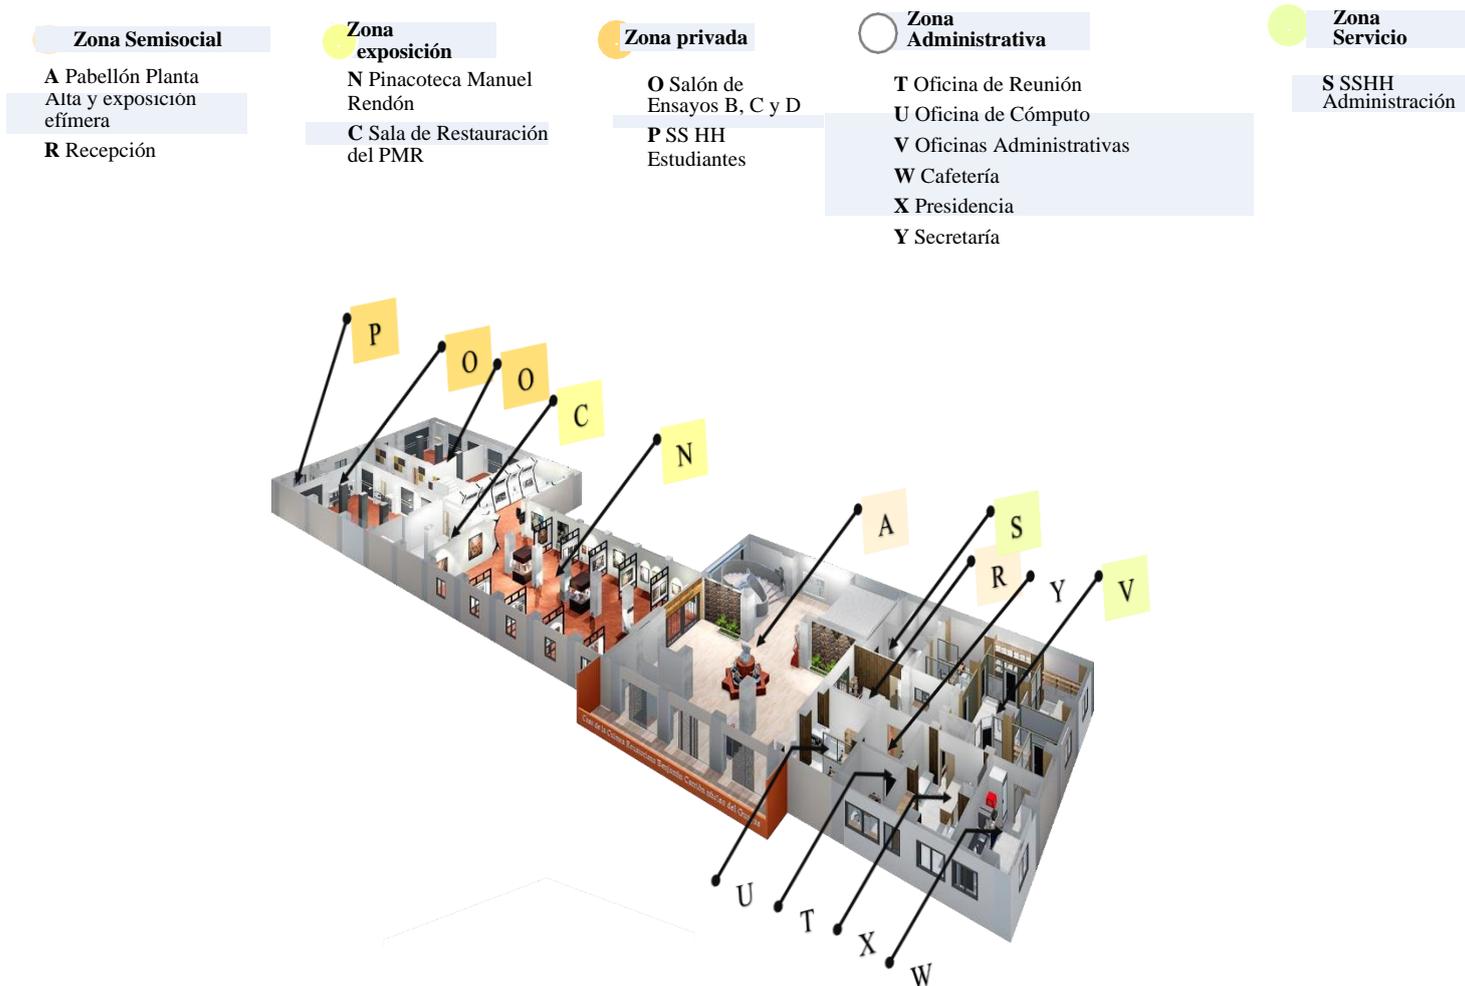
Isométrica de la Propuesta en Planta Baja núcleo del Guayas.
